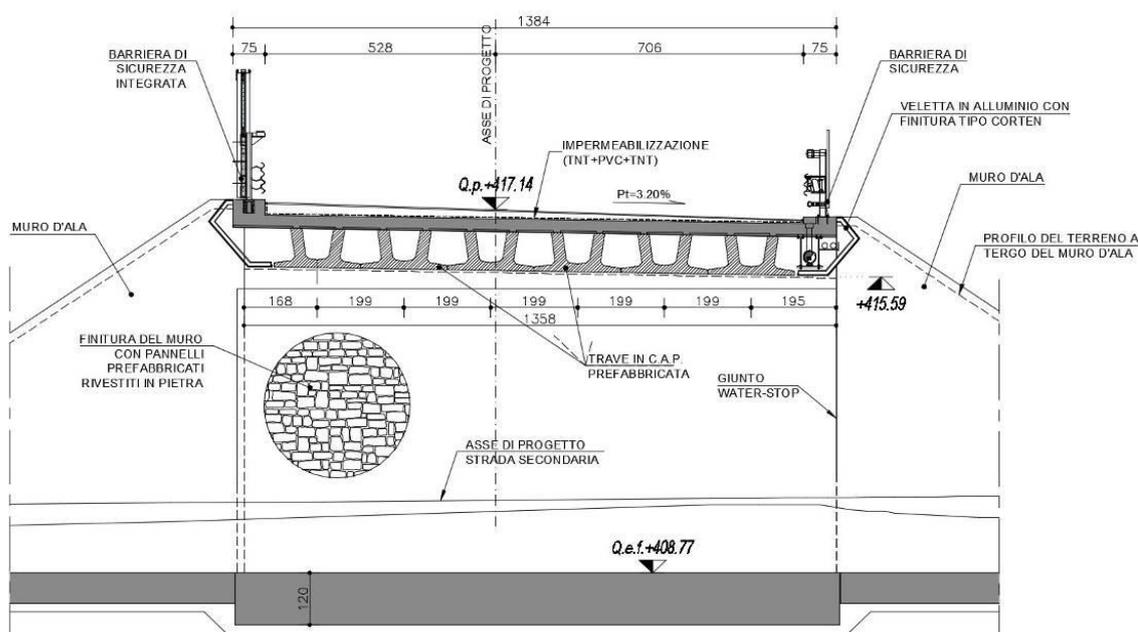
SEZIONE TRASVERSALE SOTTOPASSO PK 3+603.18
